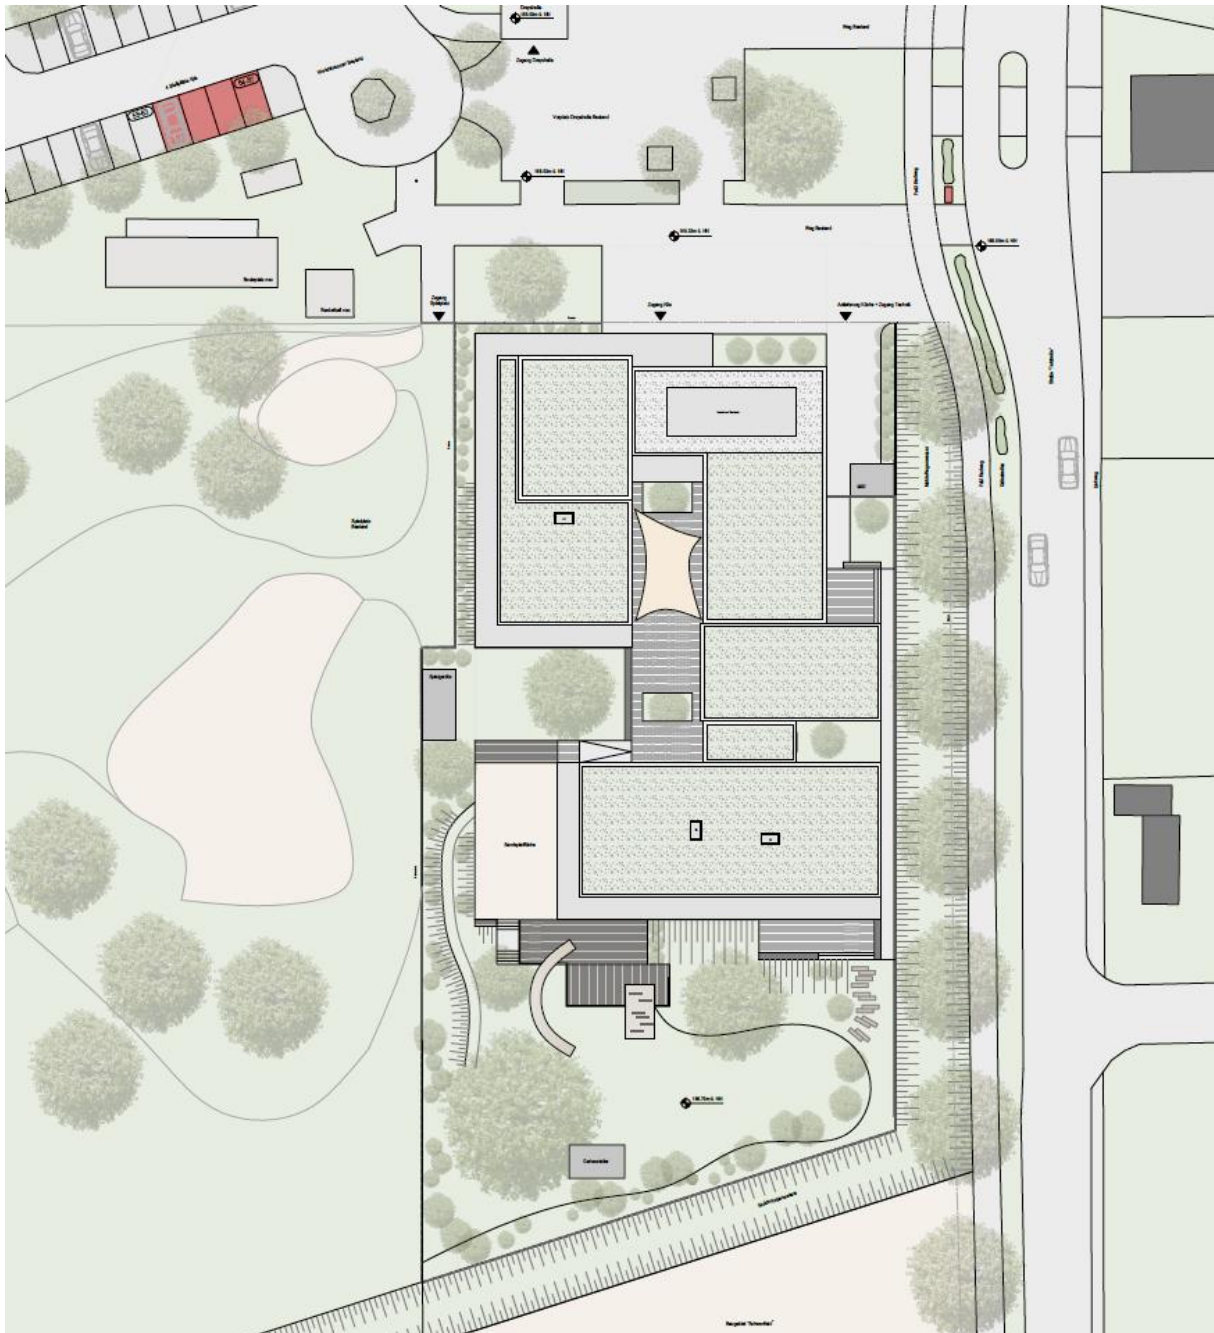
Lageplan Entwurf Kita (Schuh+Weyer Architekten, 13.10.2025), Planung nicht verbindlich
